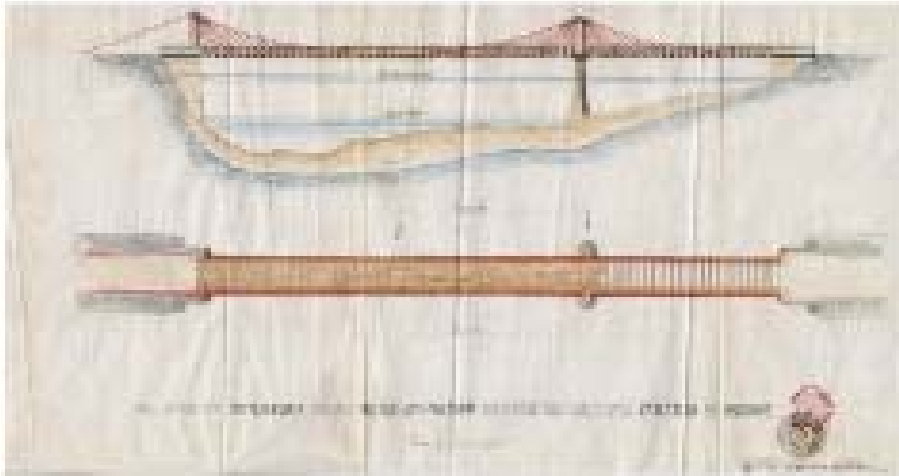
Pianta e prospetto, Cancello Arnone, ing. Tessitore;
